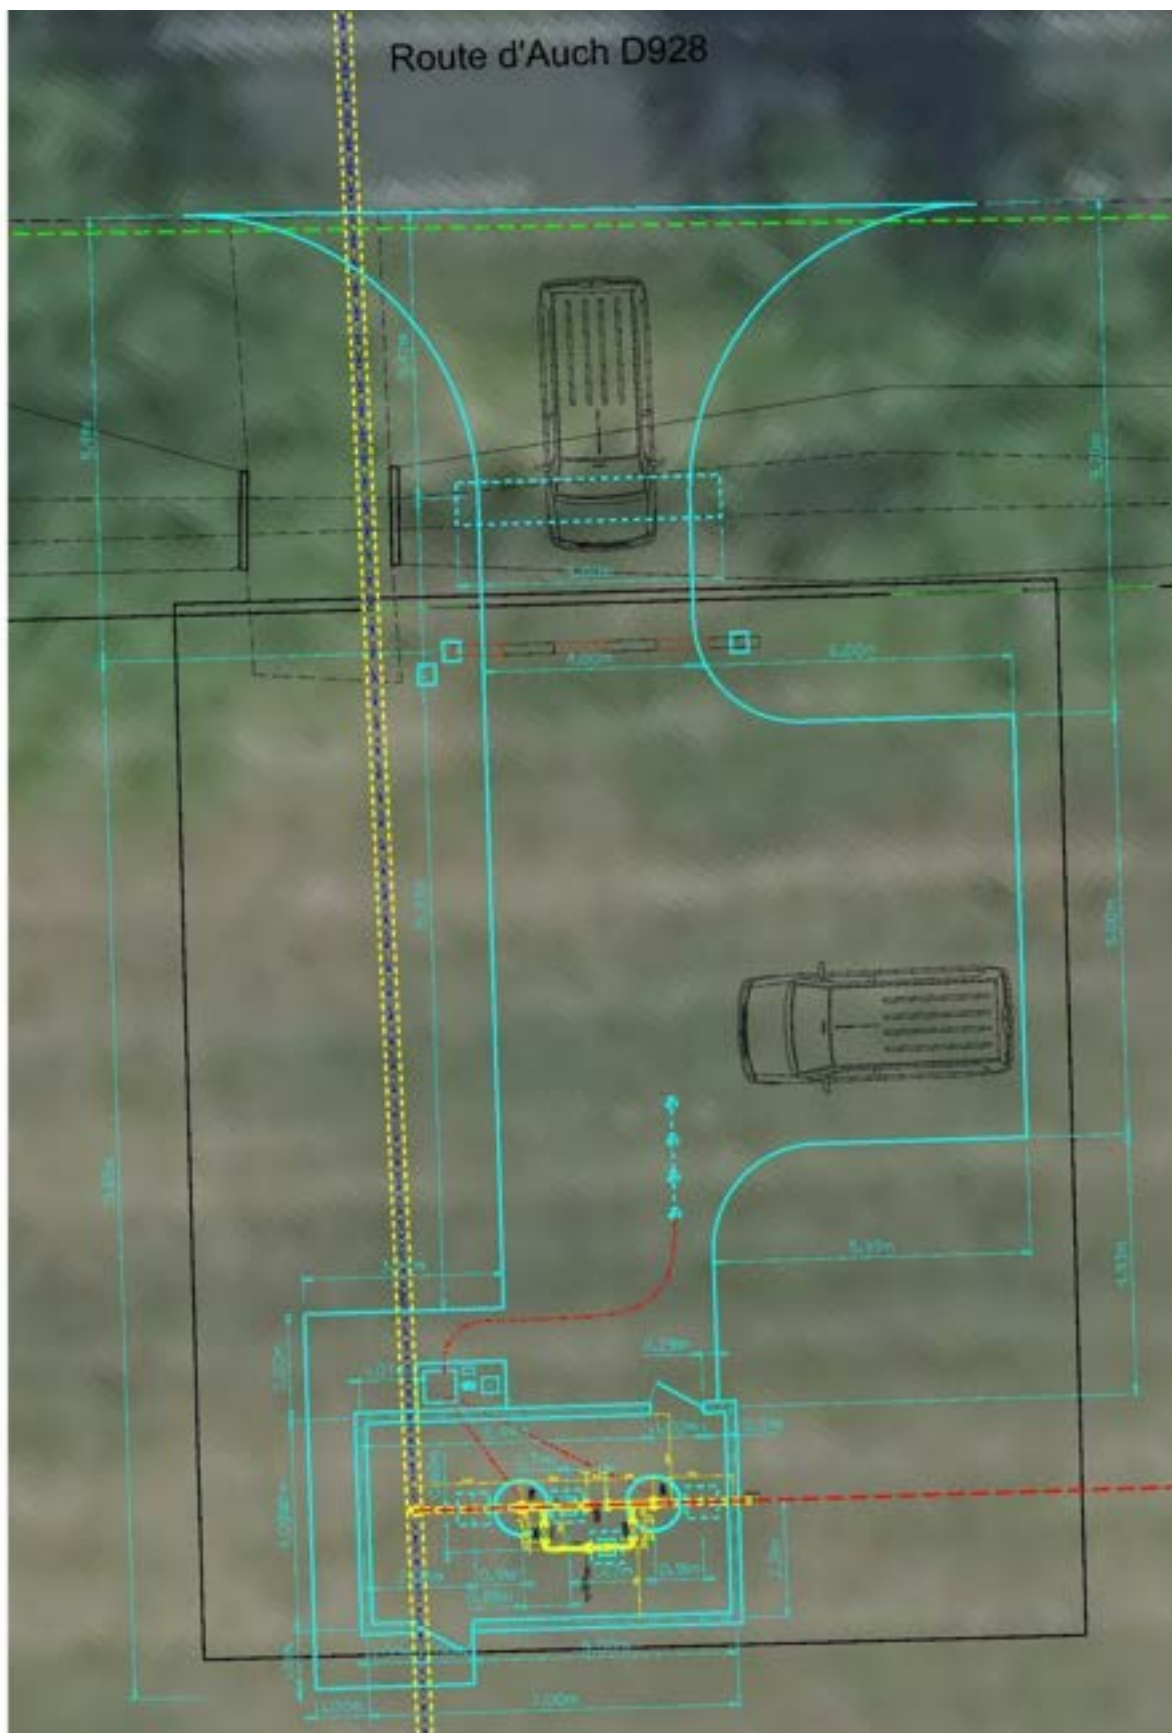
Plan d'implantation du poste de sectionnement Montauban ZI Parages
